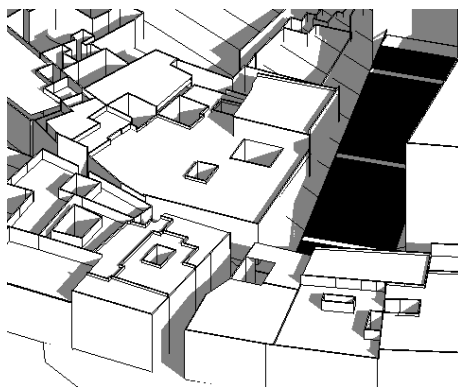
Casa del Marqués de Rayas y construcciones cercanas vista en 3D. Elaboración Propia
